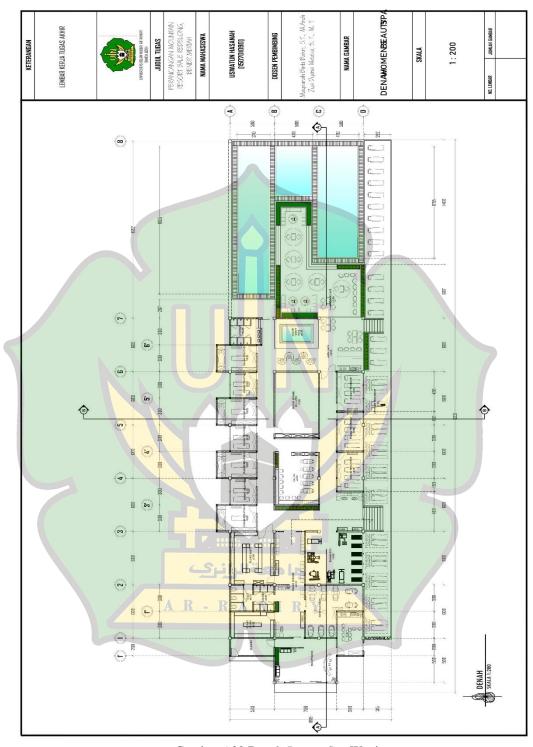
Denah Bangunan Utama Lt.2 Sumber : Rancangan Pribadi
